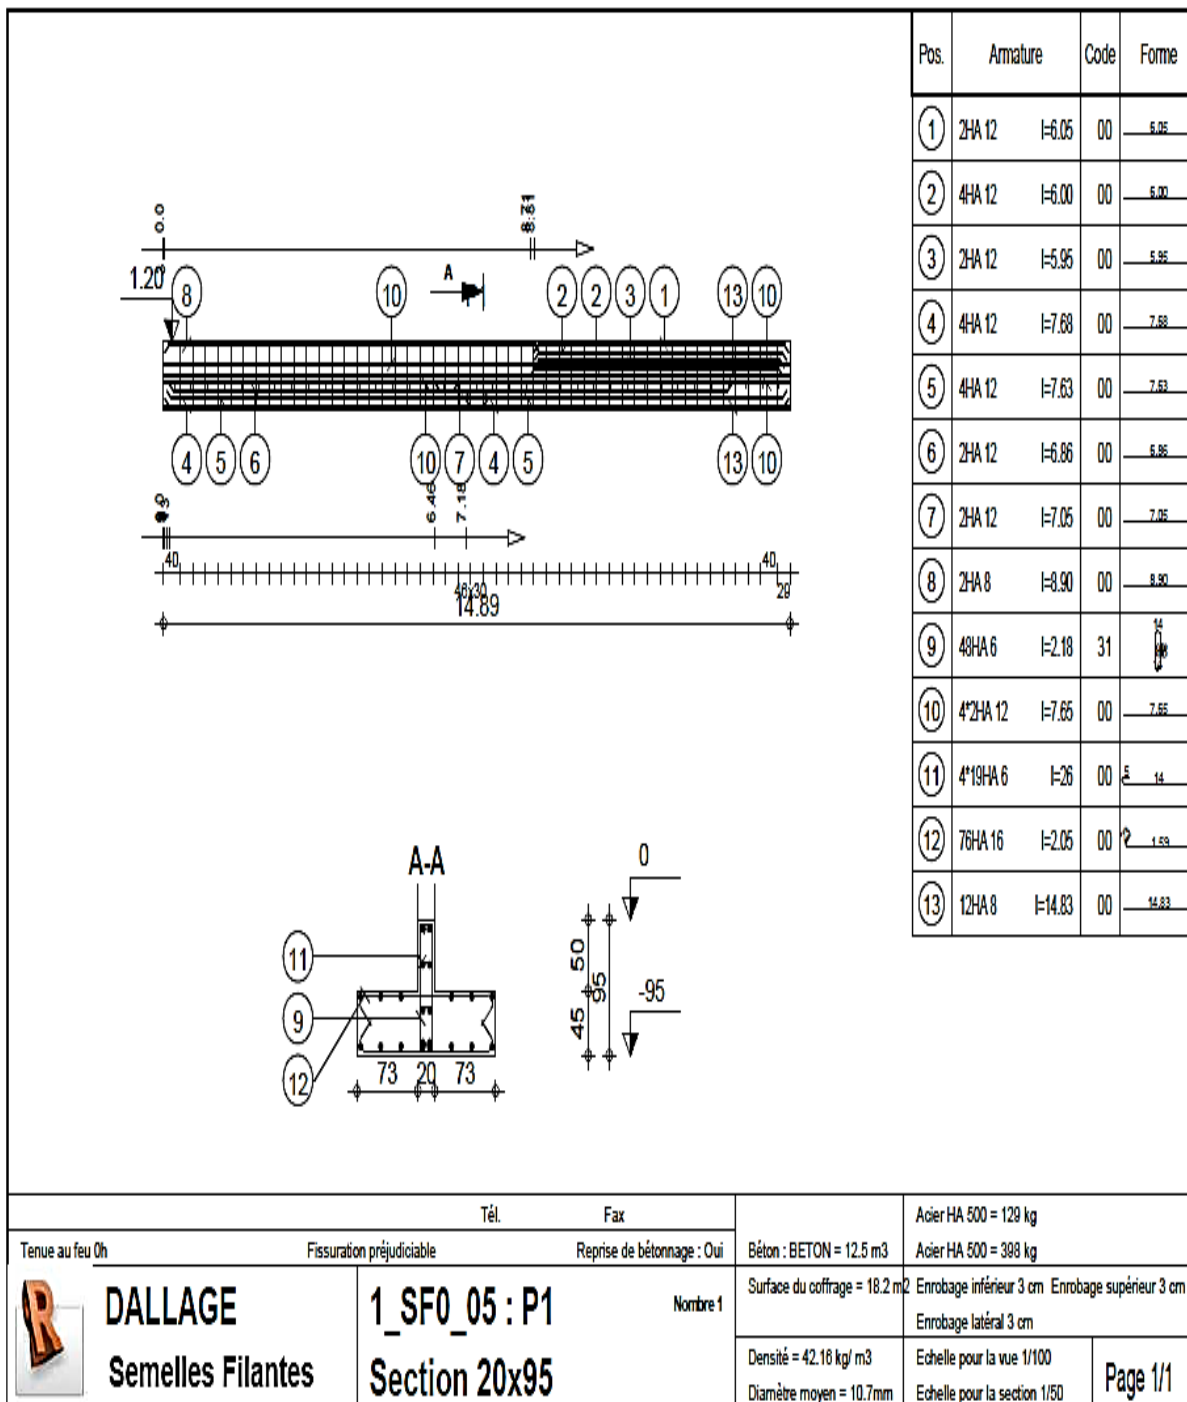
Plan d'exécution de la semelles filante SF0_05 , Bloc 1, Tranche 1.
